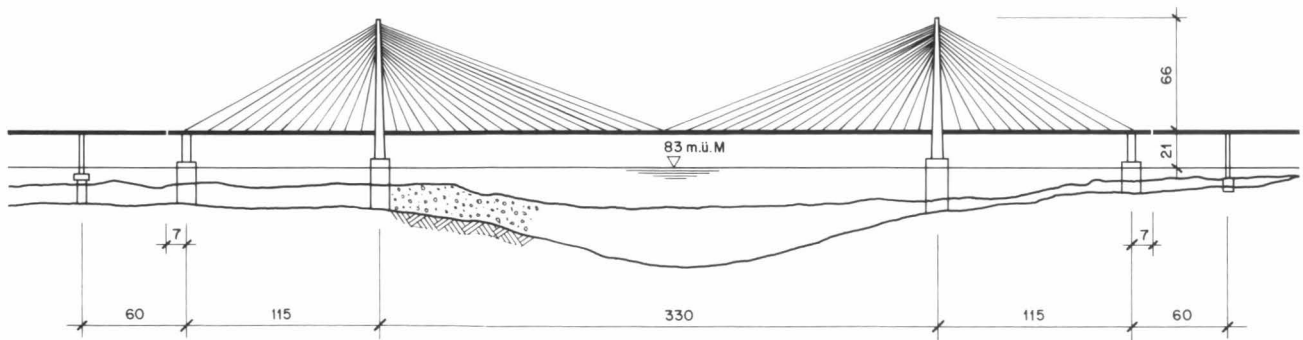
Längsschnitt der Hauptstrombrücke (Masse in m) – Coupe longitudinale du pont principal (dimensions en m) – Elevation of the mainstream bridge (Dimensions in m)
